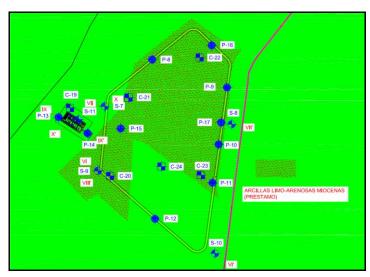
Localización de los trabajos de campo. Planta balsa Sector III.
